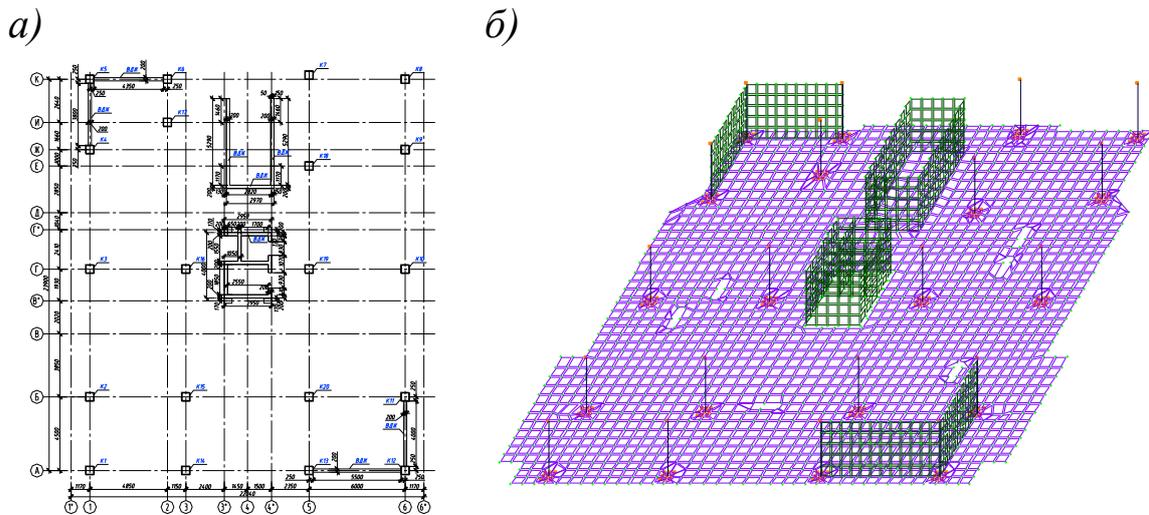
План здания по 2-му варианту (а) и разработанный фрагмент КЭМ
